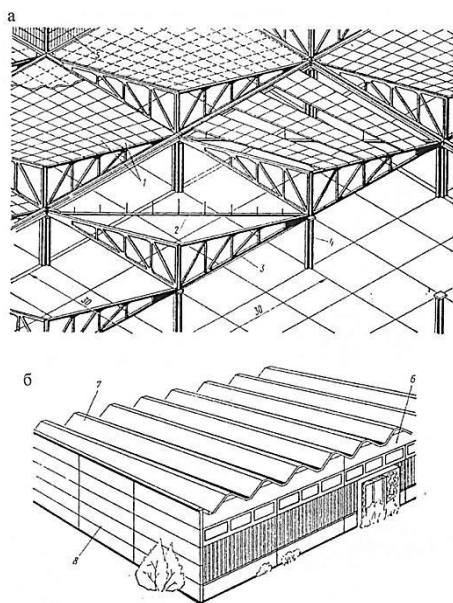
Железобетонные оболочки покрытий типа гипар (гиперболический параболоид):
